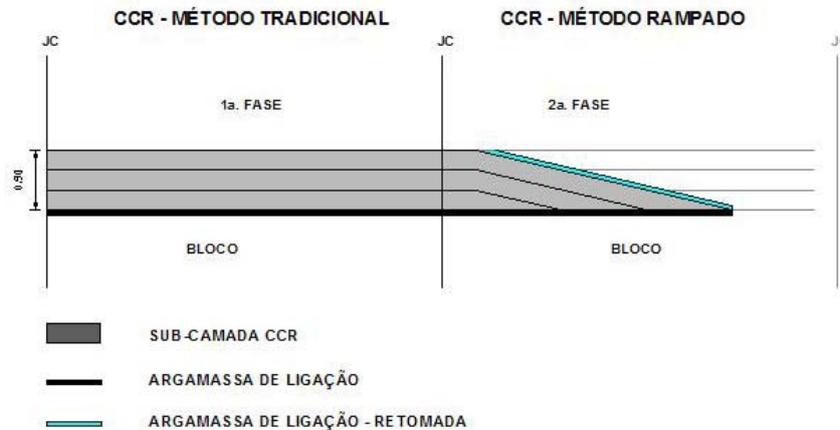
Camadas de CCR lançadas horizontalmente e rampadas [17].
